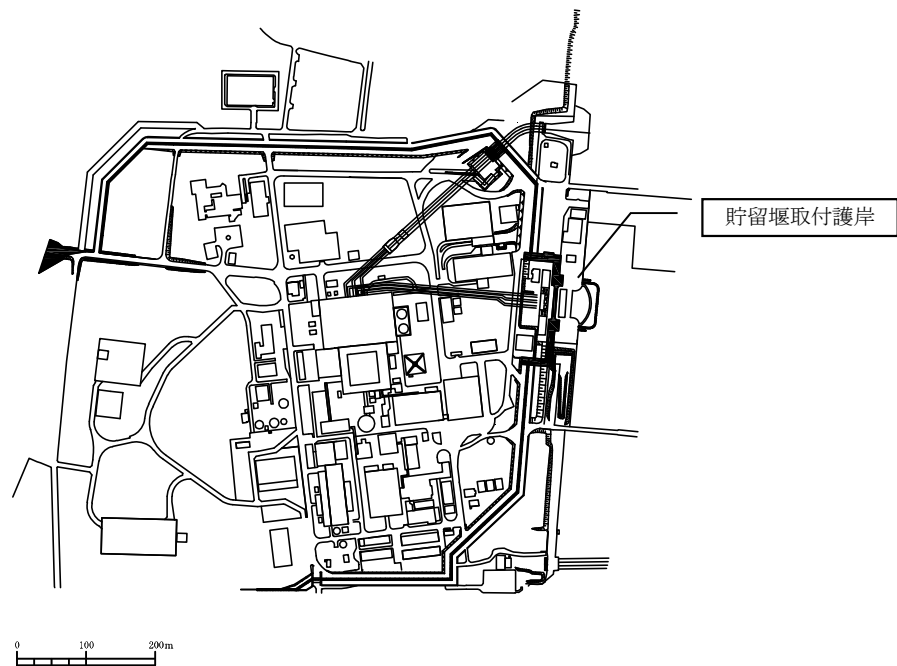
(1) 貯留堰取付護岸の平面配置図 (全体図)
